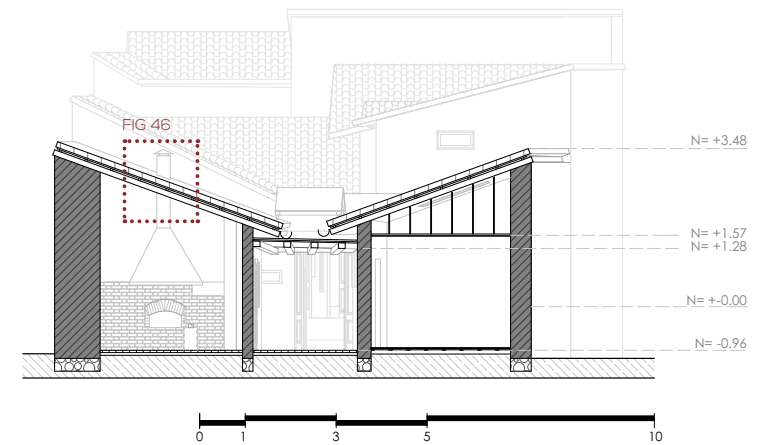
Sección transversal C - C | Caso de estudio 1, Vivienda Villacís.
